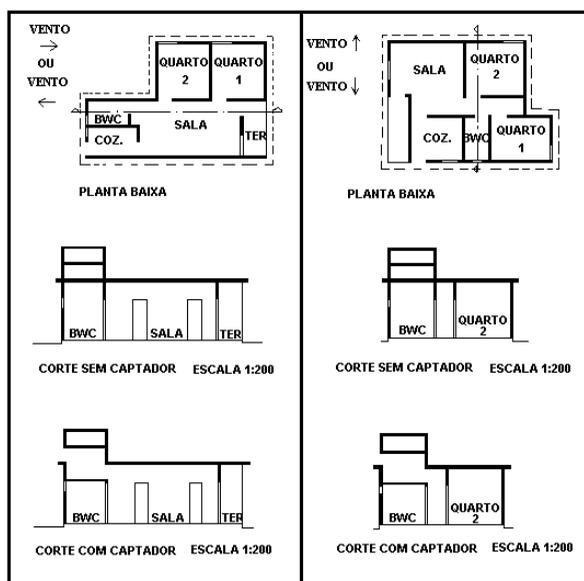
Planta baixa e cortes das unidades habitacionais dos conjuntos Salvador Lyra e Graciliano Ramos, respectivamente
